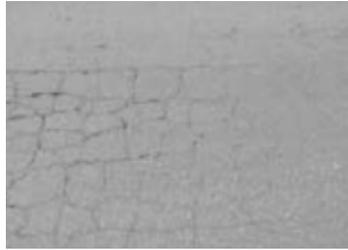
Fisura en bloque en la Calle 38, Cristo Rey.
